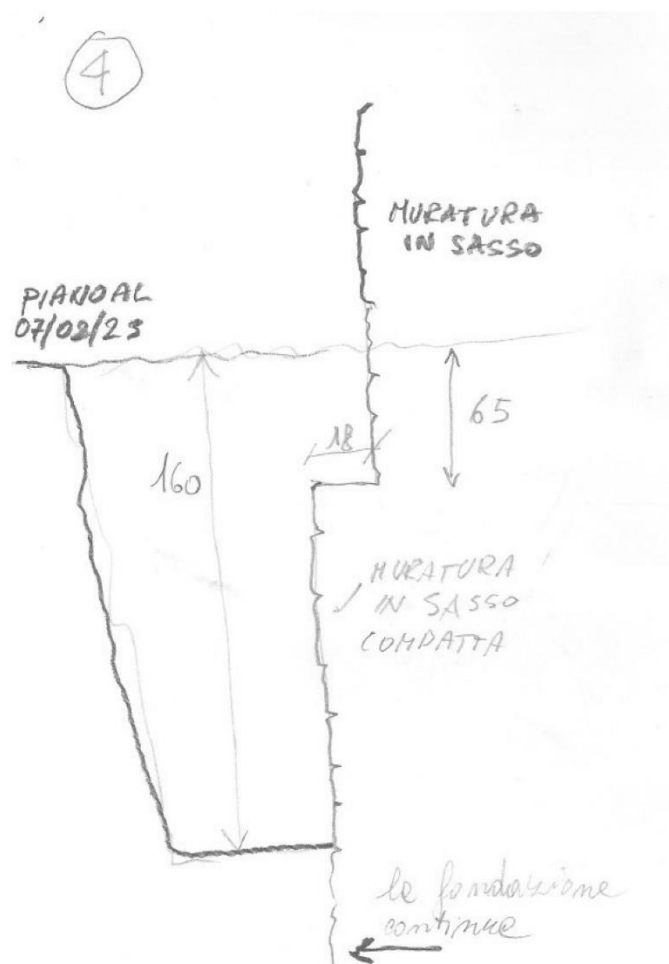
Sondaggi fondali (disegno Arch. Davide Cristofani)
